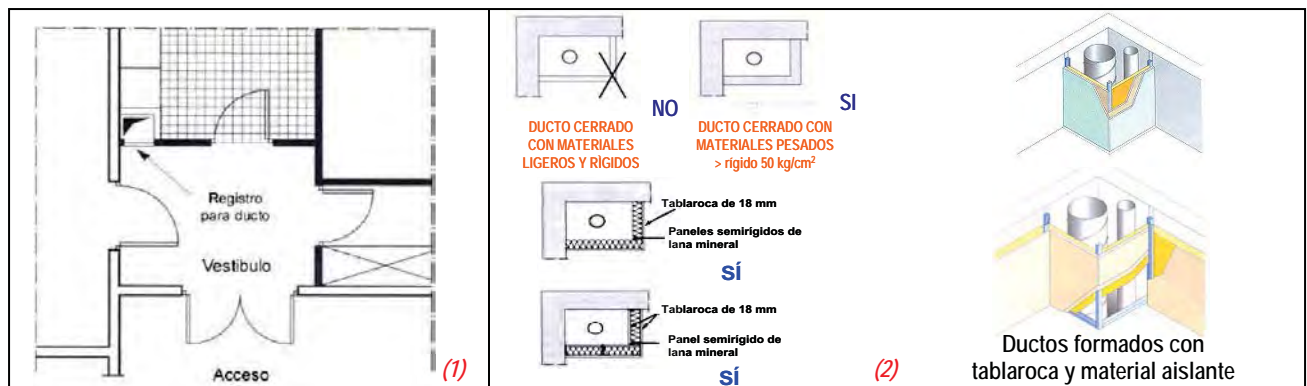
UBICACIÓN PREFERENTE Y AISLAMIENTO ACÚSTICO DE DUCTOS DE INSTALACIONES
